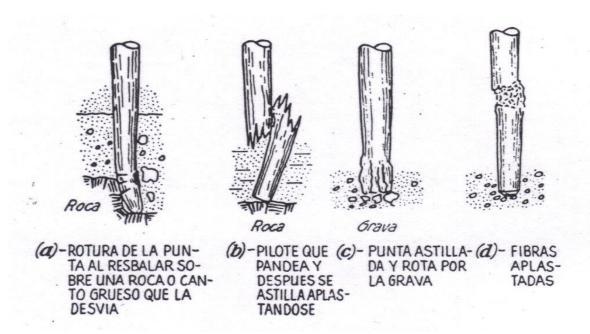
Algunas formas de fallo en los pilotes de madera cuando se prosigue la hinca después de que han tropezado con un obstáculo.
